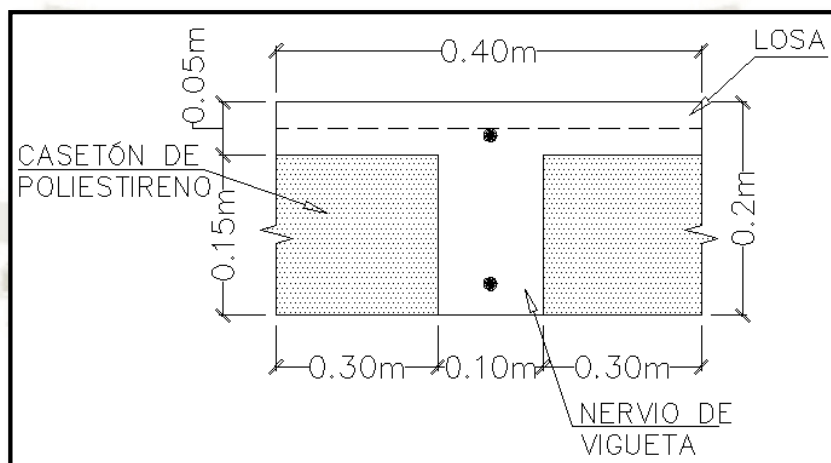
Sección típica de vigueta (Fuente: Elaboración propia)
